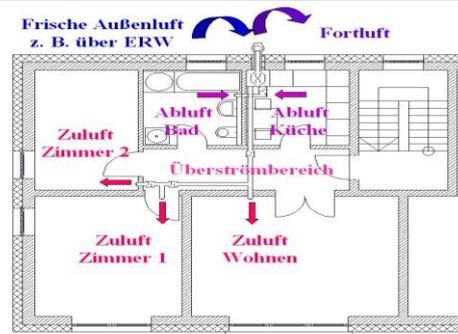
Zu-/Abluftanlage mit WRG (Grundriss)
